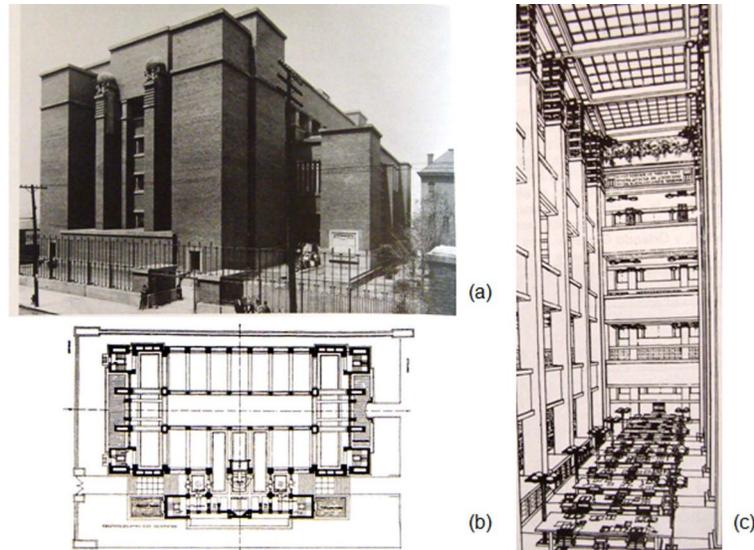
Frank Lloyd Wright, Edificio Larkin, Buffalo, E.U.A. (1904): (a) Vista exterior, (b) Planta común, (c) Detalle de la nave central.
